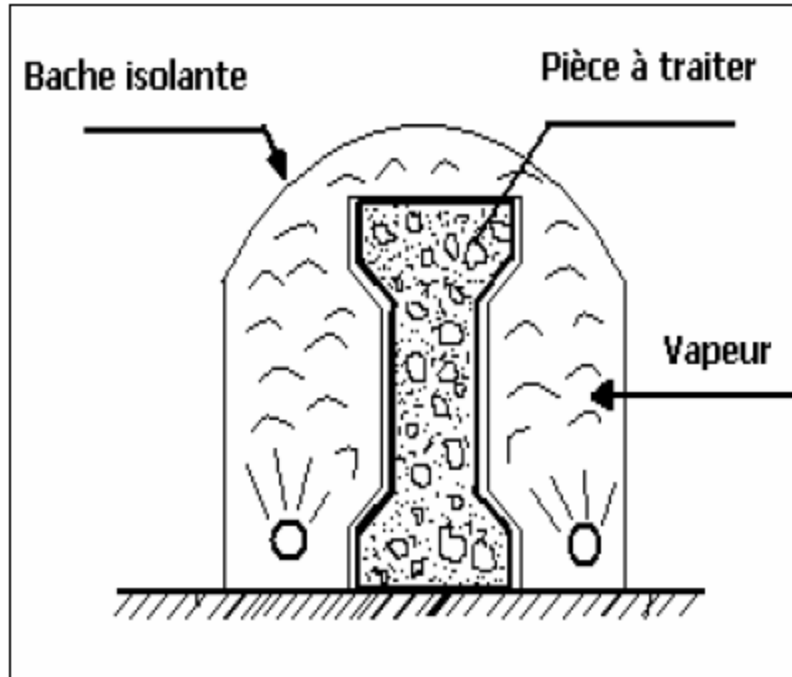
Chauffage d'une poutre sous bâche par vapeur perdue.
